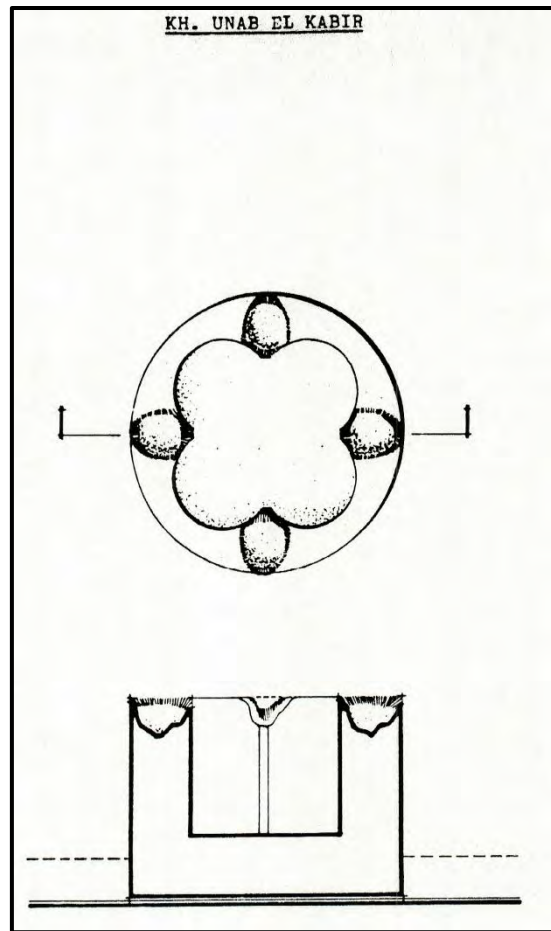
Khirbet Unab el-Kabir. Pianta e sezione del fonte battesimale
